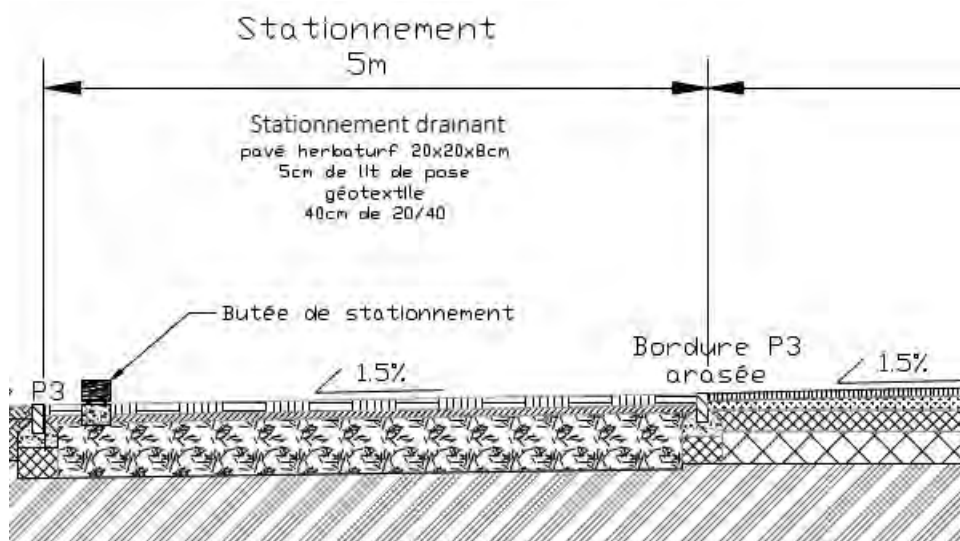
Coupe sur la structure drainante au droit des stationnements (Source : SODEREF)
